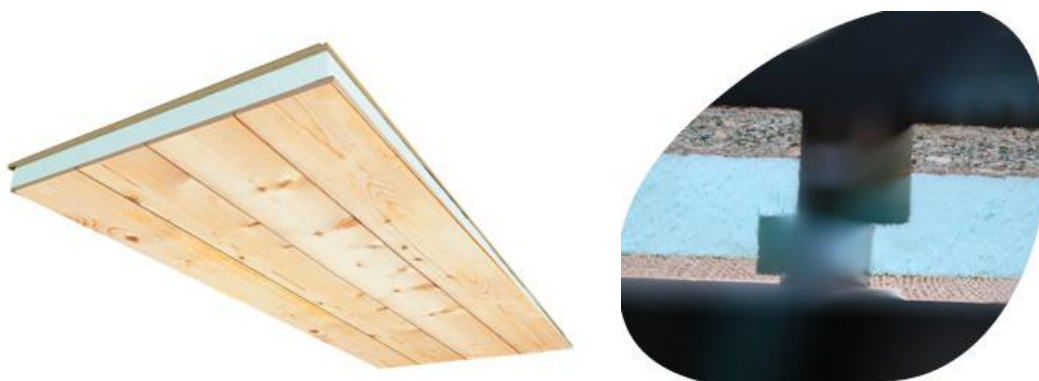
Panel tipo sándwich de madera / detalle de traslape
